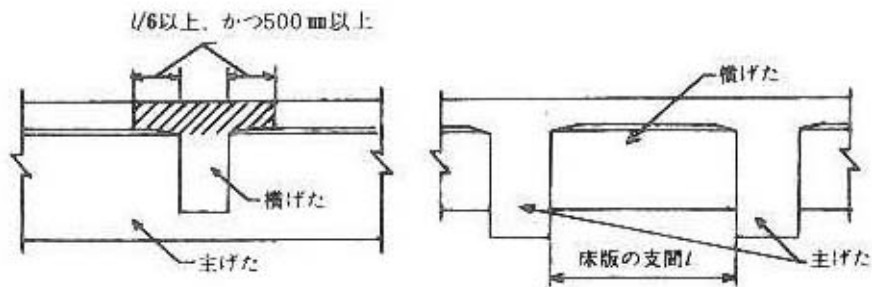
横げた上の床版の上側鋼材の配置範囲
